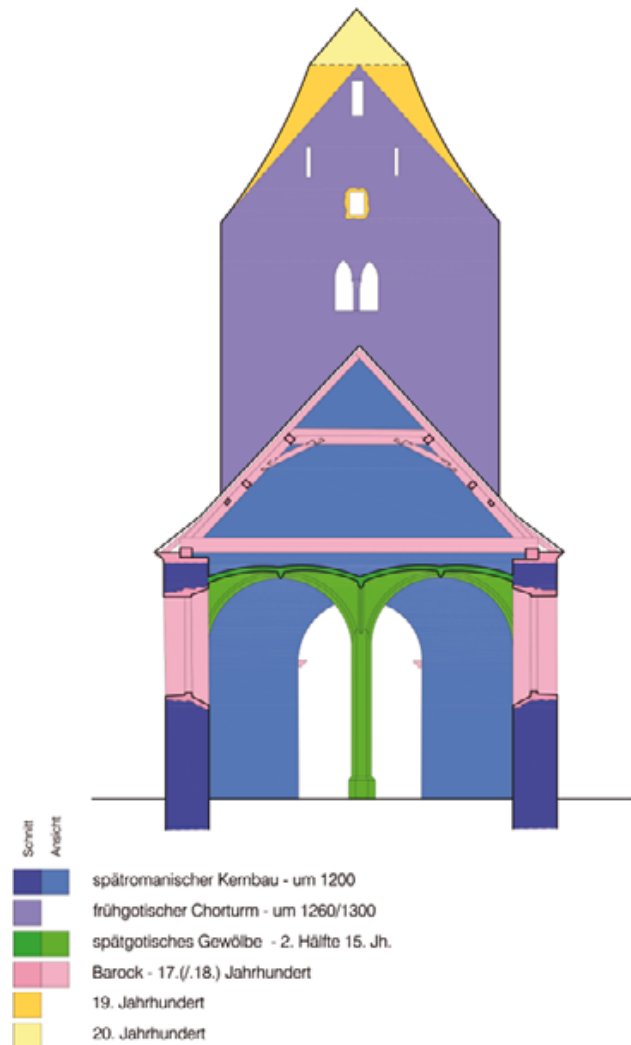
Sallingstadt, Pfarrkirche hl. Martin. Schnitt durch das Langhaus mit dem Chorturm (Ansicht gegen Osten).
